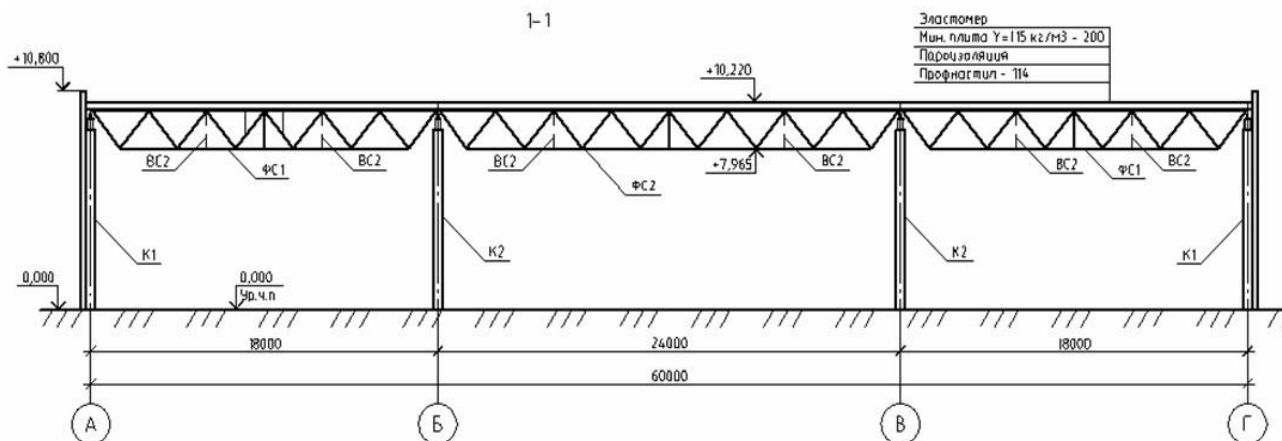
Поперечная рама каркаса здания с конструкциями типа «Молодечно»
